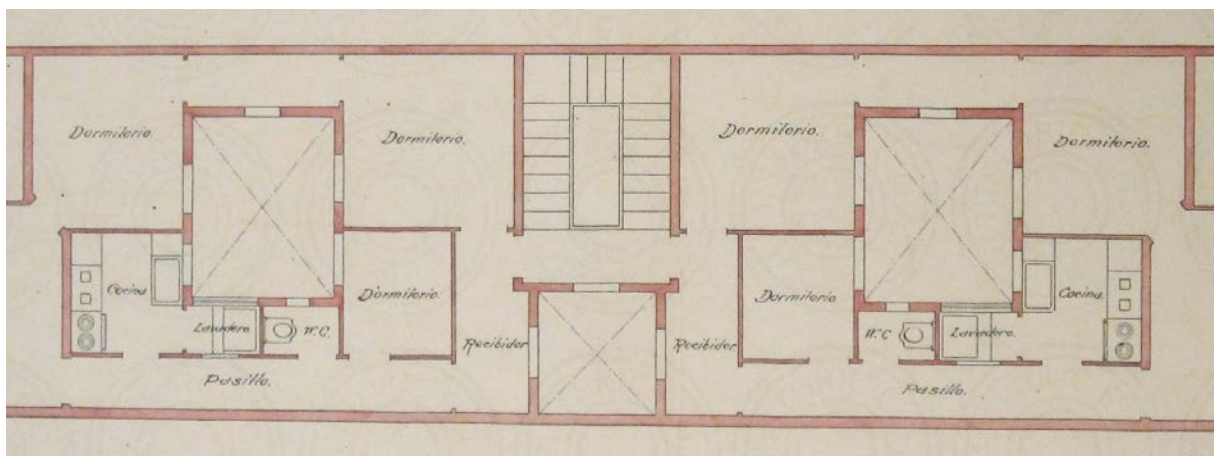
Detall de plànol de planta pis (casa Joan Flotats, arquitectes Bassegoda, 1925). Font: AHCOAC H115I/6/251.
